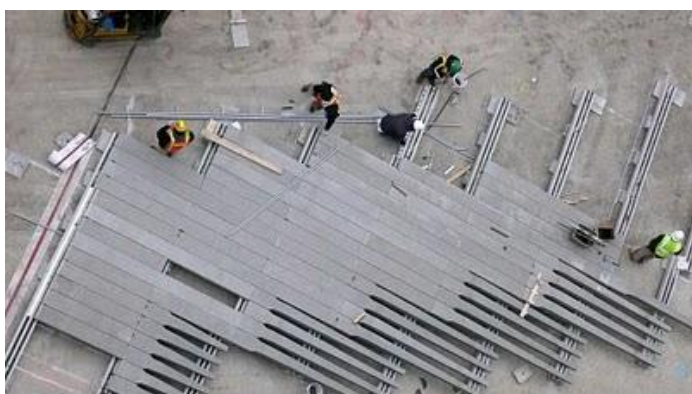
Grelha de concreto e aço instalada sobre o elevado metálico.
